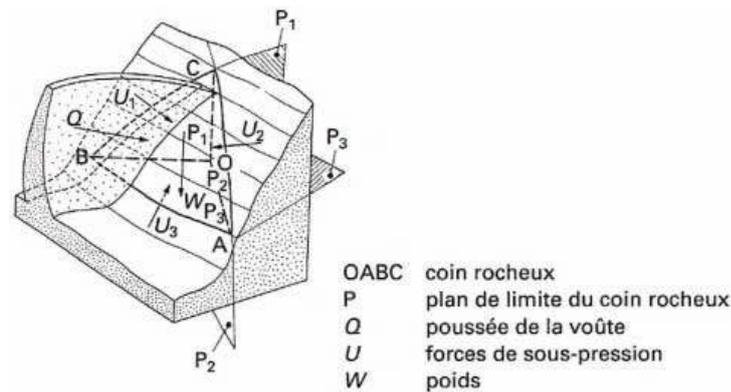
Étude de la stabilité d'une rive (méthode de Londe)
